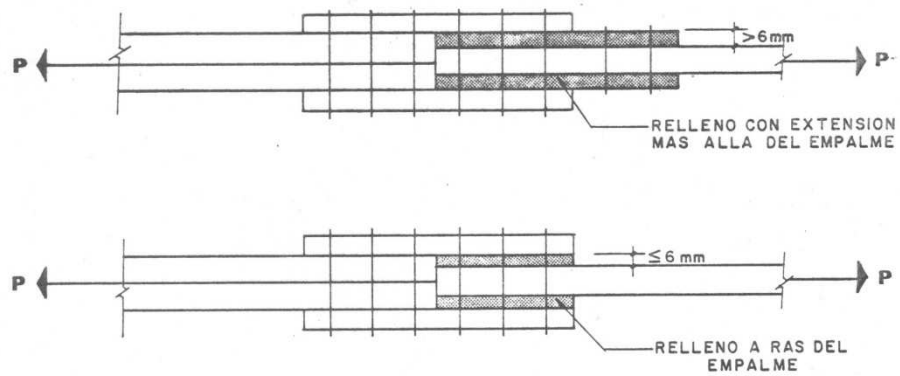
ILUSTRACION DEL USO DE LAS PLANCHAS DE RELLENO
